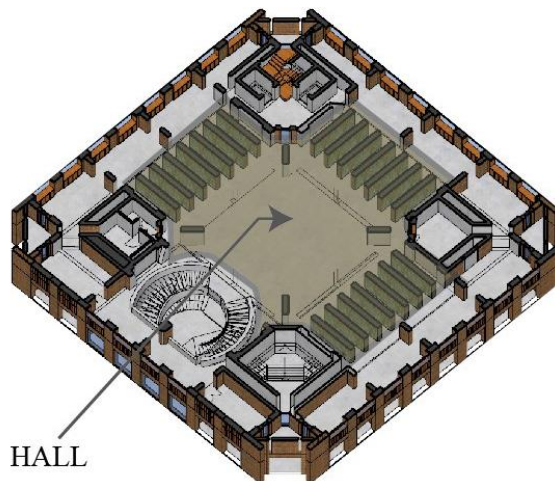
Hall y galería de la biblioteca de Lois Khan
